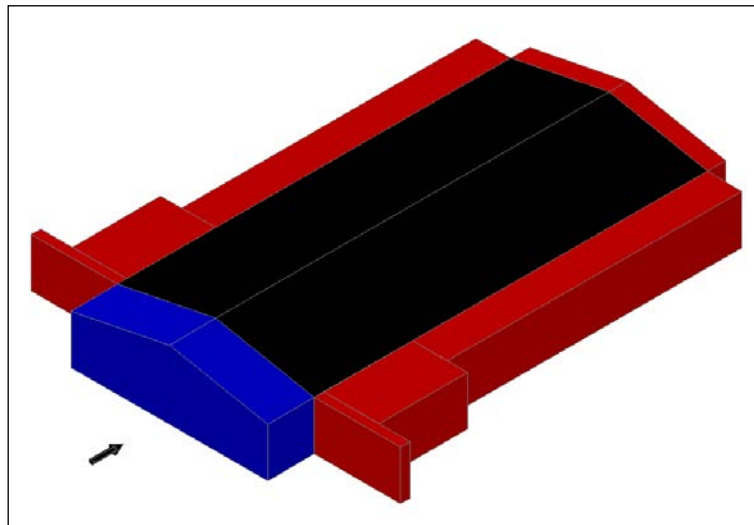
Vent longitudinal façana. Blau pressió, vermell succió
